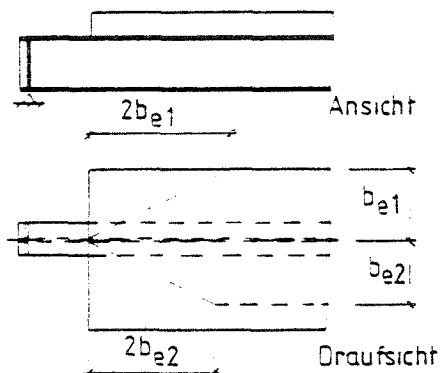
Mitwirkende Breite eines Betongurtes im Bereich der Einleitung einer konzentrierten Last in der Ebene der Platte
